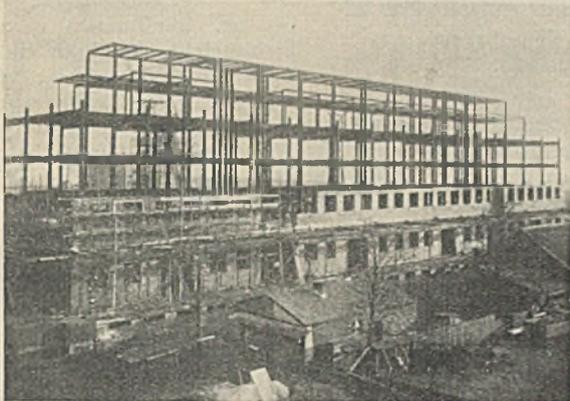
Stahlskelett des Hauptlagerhauses der Gutehoffnungshütte in Oberhausen.
